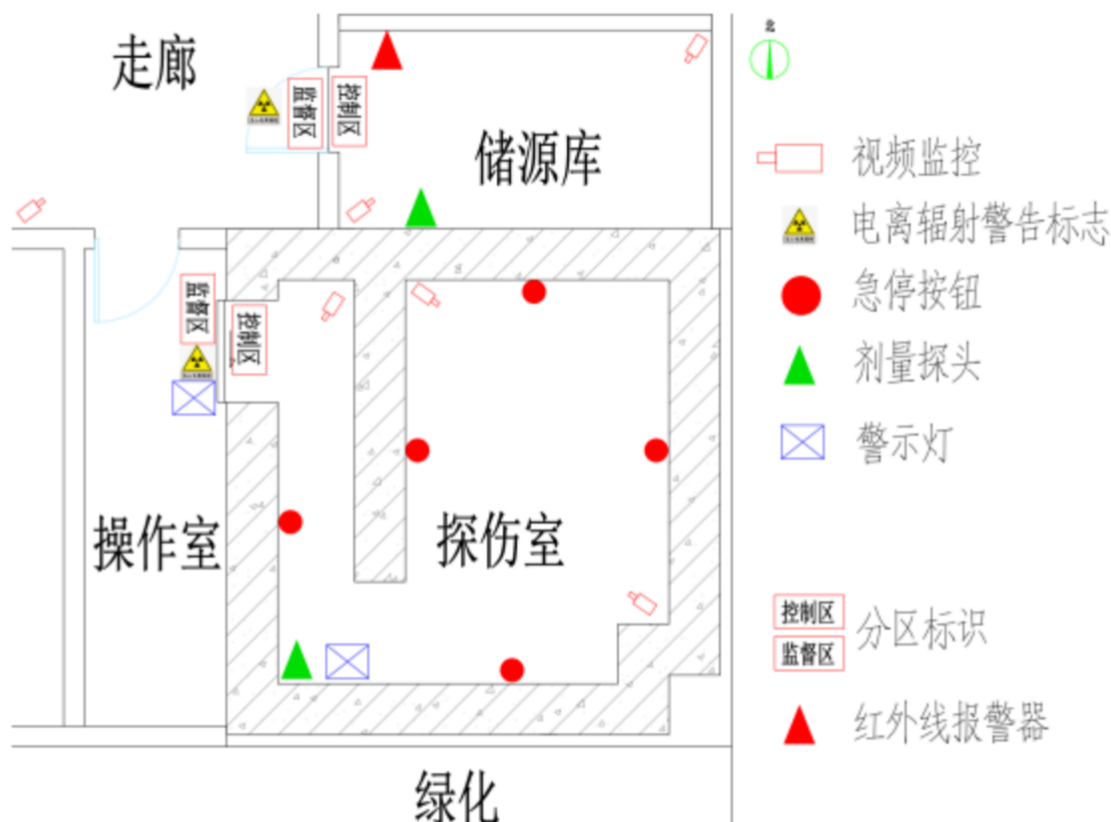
白市驿基地辐射安全与防护设施布置示意图
